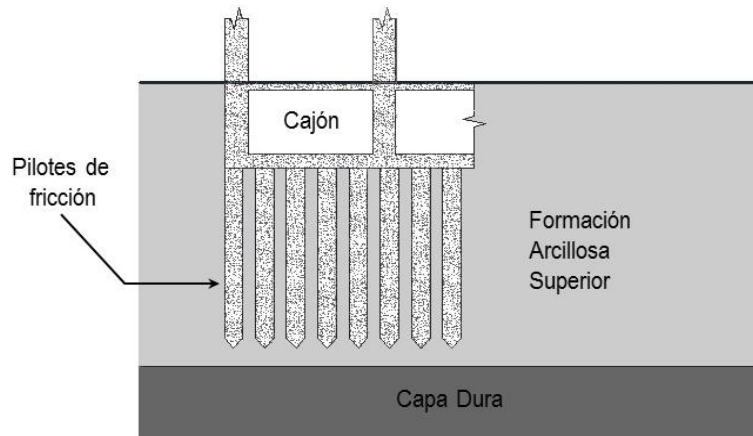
Esquema de cimentación compensada con cajón y pilotes de fricción.
